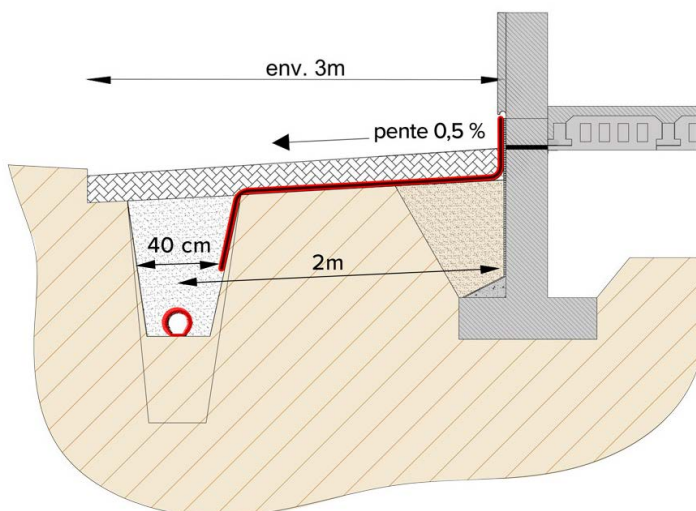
POSITIONNEMENT A DISTANCE DES FONDATIONS AVEC MEMBRANE D'IMPERMÉABILISATION
